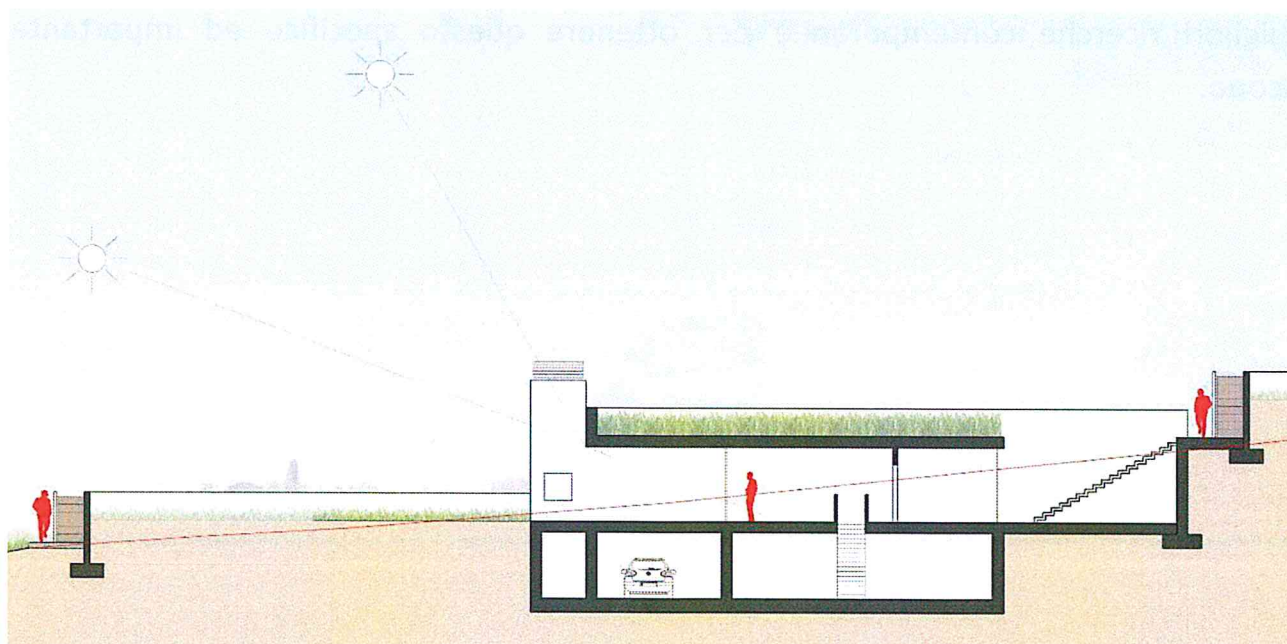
Sezione trasversale di dettaglio della Fascia 1 - stato di progetto (con orientamento solare).
